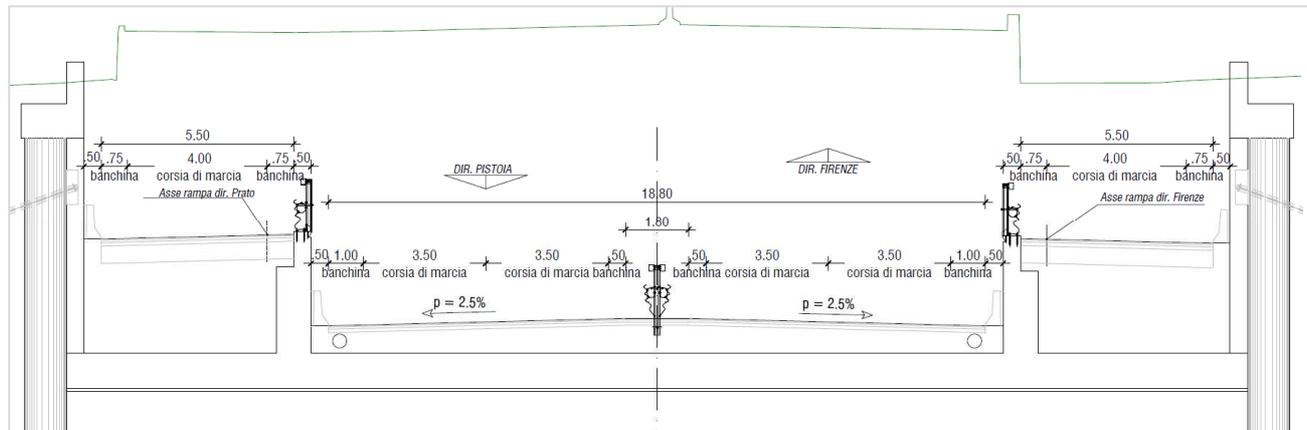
Sezione tipo "ASSE PRINCIPALE CON RAMPE IN AFFIANCAMENTO"
